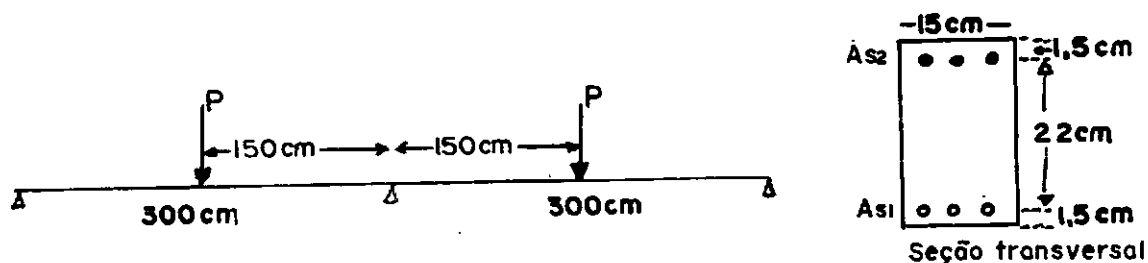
Esquema de ensaio das vigas contínuas
